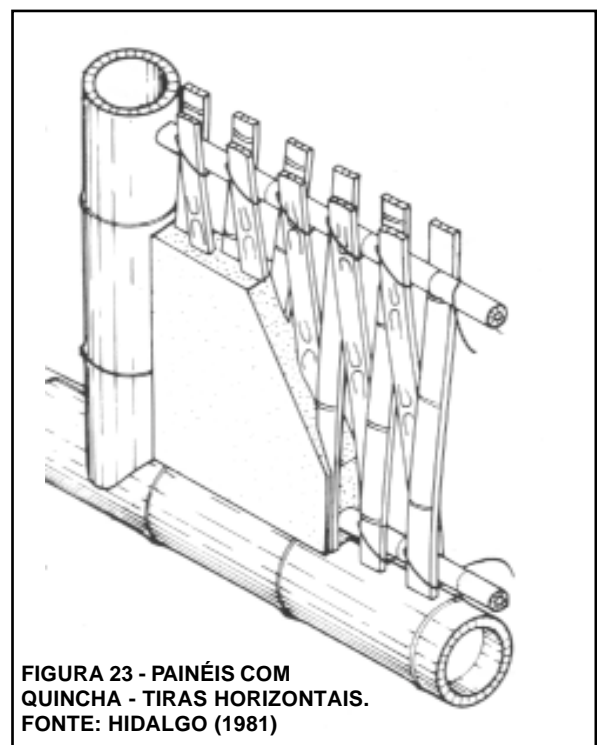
PAINÉIS COM QUINCHA - TIRAS HORIZONTAIS.
